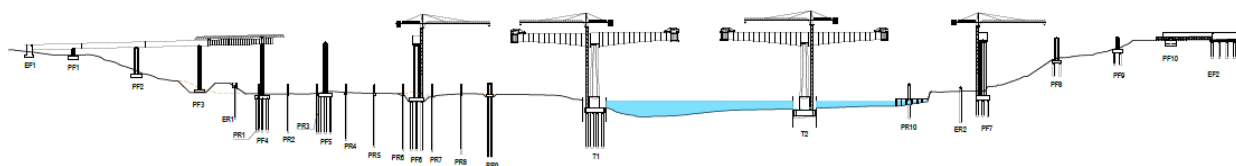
Faseamento construtivo – Etapa 3 de 6
